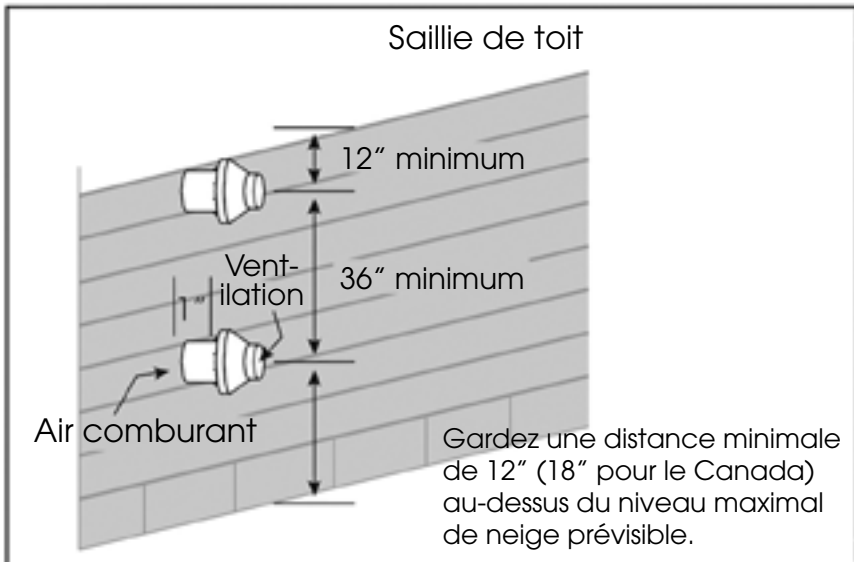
Terminaison murale latérale pour plusieurs ventilations concentriques (Verticale)
